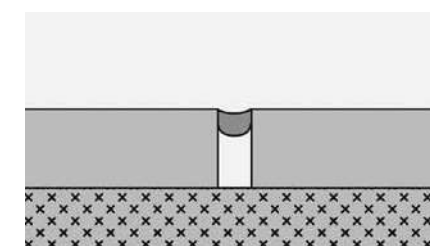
Площадь контакта сварочного шнура и покрытия слишком маленькая. При этом прочность сваренного шнура примерно 10-15 N/CM.
